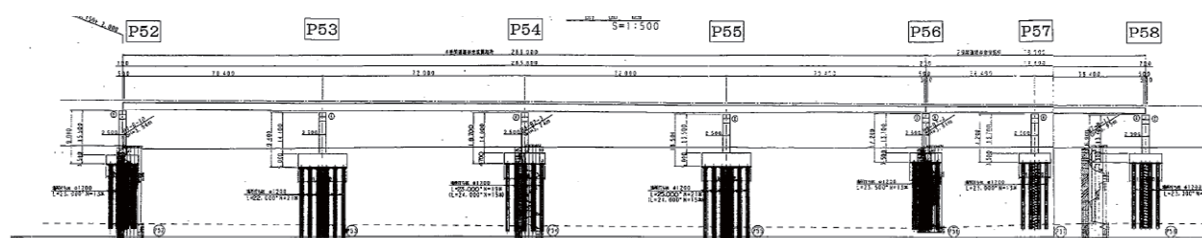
側面図(東部高架橋 P52~P58)
